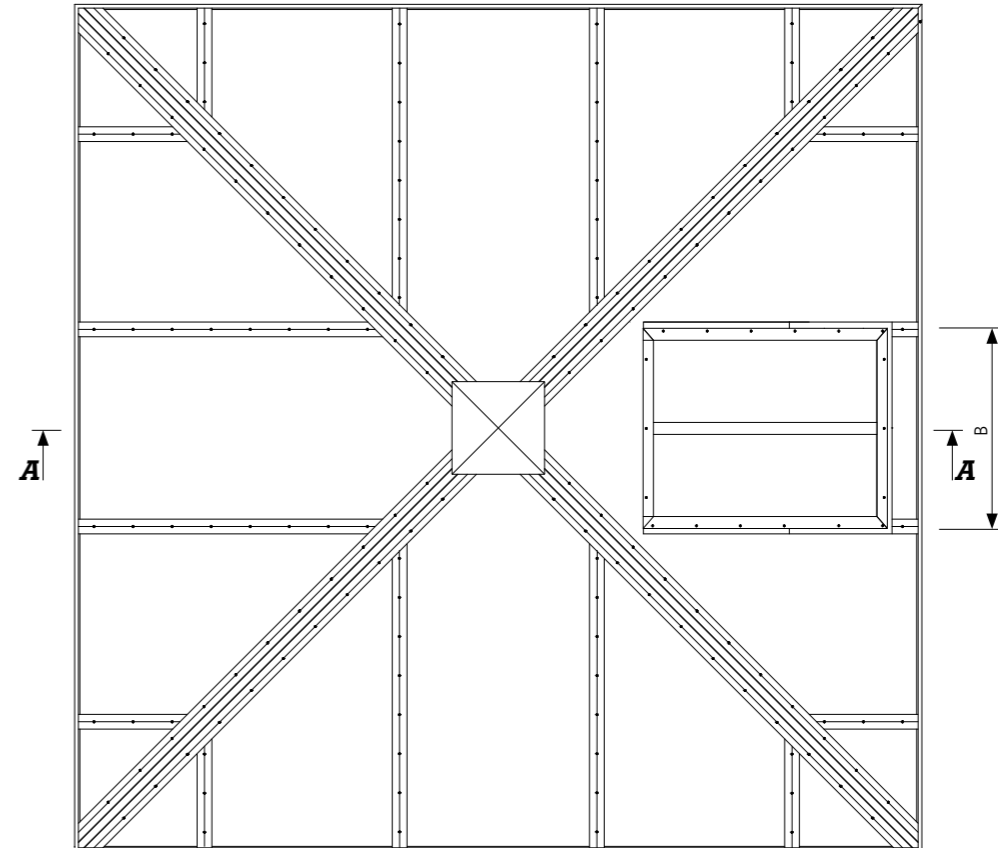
Draufsicht von einem pyramidenförmigen Oberlicht Typ mcr PROLIGHT mit eingebauter Lüftungsklappe
